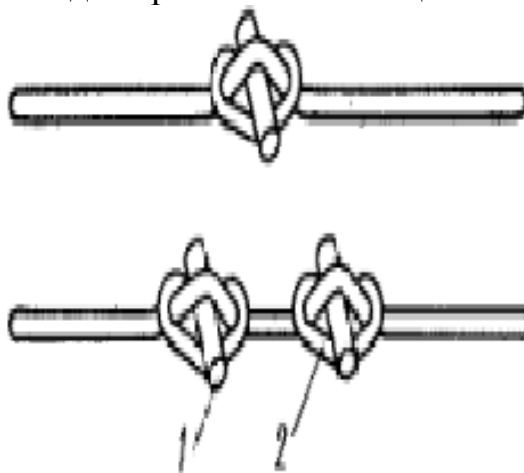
Анкеровка напрягаемой арматуры: 1 – коротыш; 2 – кольцо
